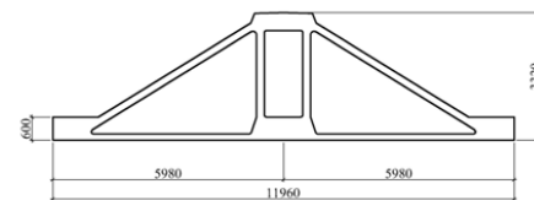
Підкроквяна ферма для покрівлі малого ухилу
